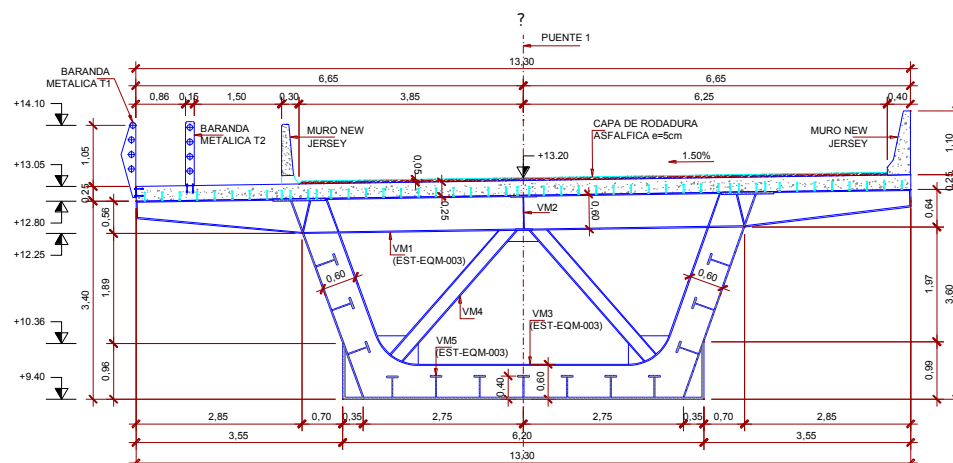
Corte transversal de la superestructura con rigidizadores cada 5.00m (Fuente: Elaboración Propia)
